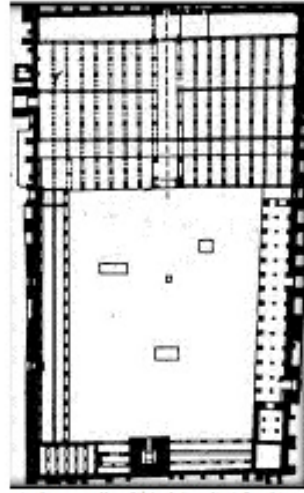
المسقط الأفقي لمسجد السور (عن مسعود البلوشي)
